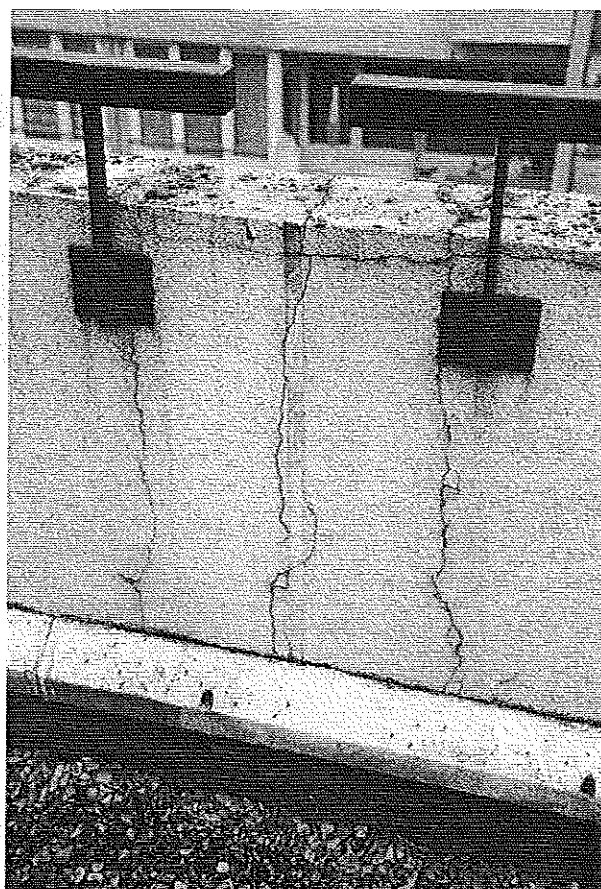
Fissurations verticales de l'acrotère :
